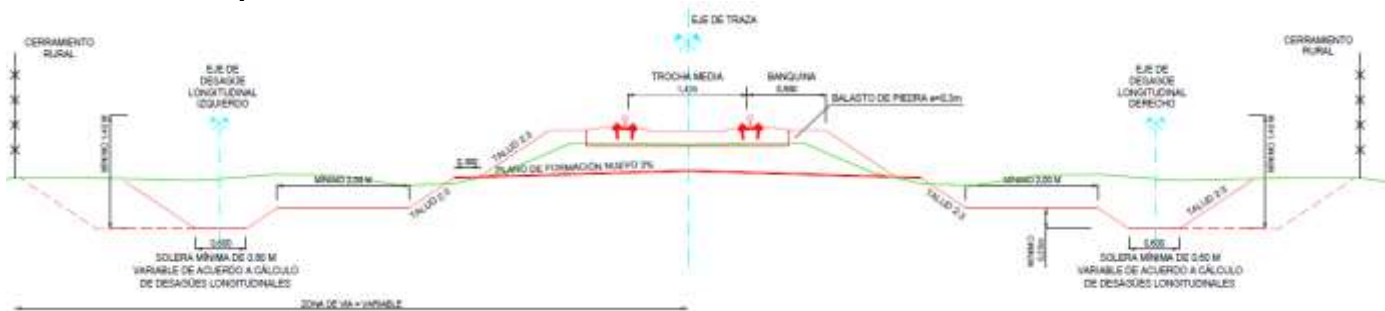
Perfil tipo Rural. Fuente: Elaboración propia.
